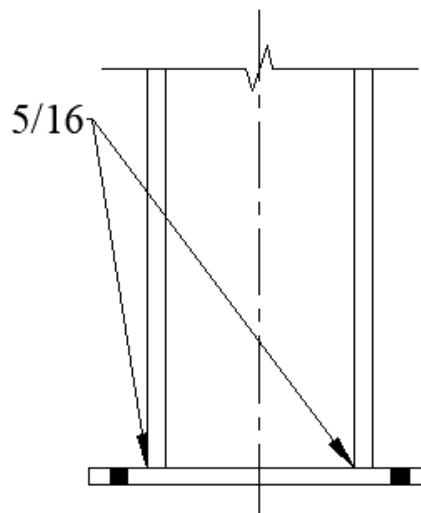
Típica soldadura de placa base para columna gravitacional
